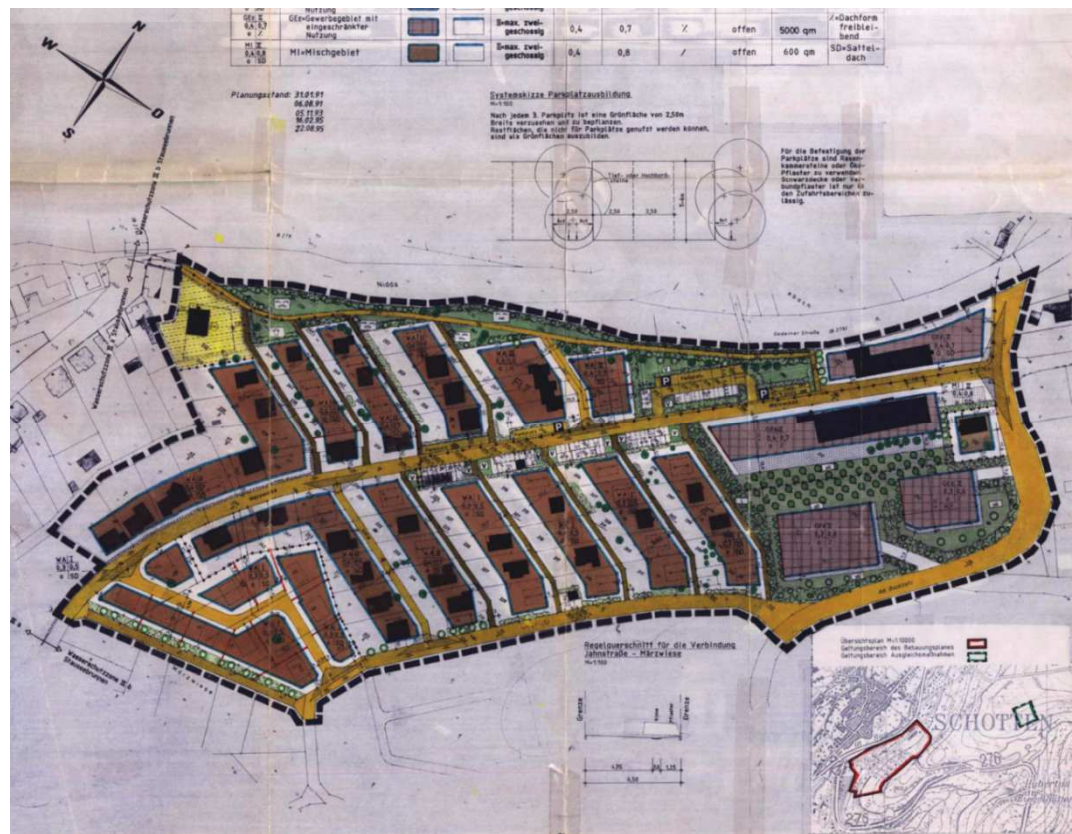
Bebauungsplan Schotten Märzweise II.
